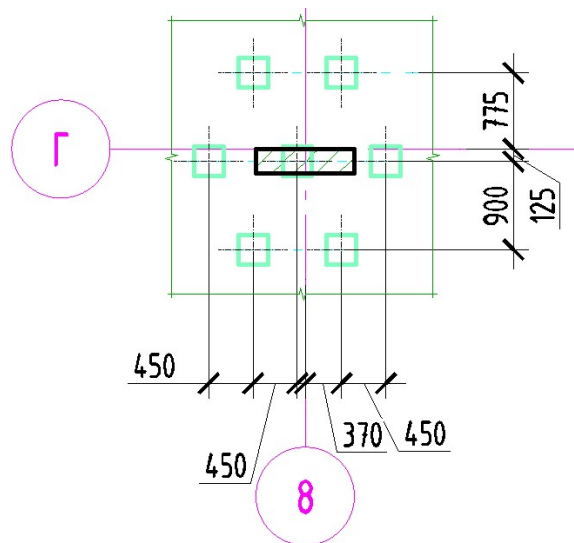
Схема расположения свай под фрагмент плитного фундамента
